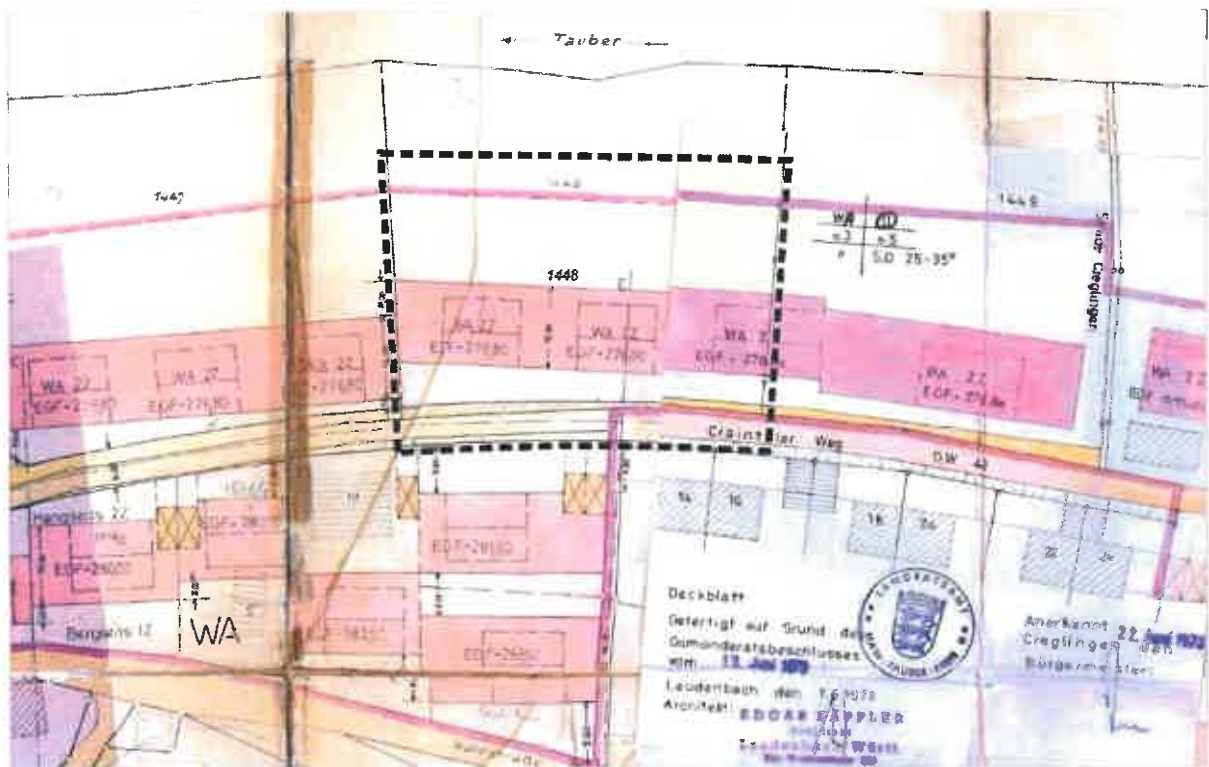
Rechtskräftiger Bebauungsplan "Craintaler Weg" bzw. "Craintaler Weg – 3. Änderung" (Ausschnitt o. M.)
